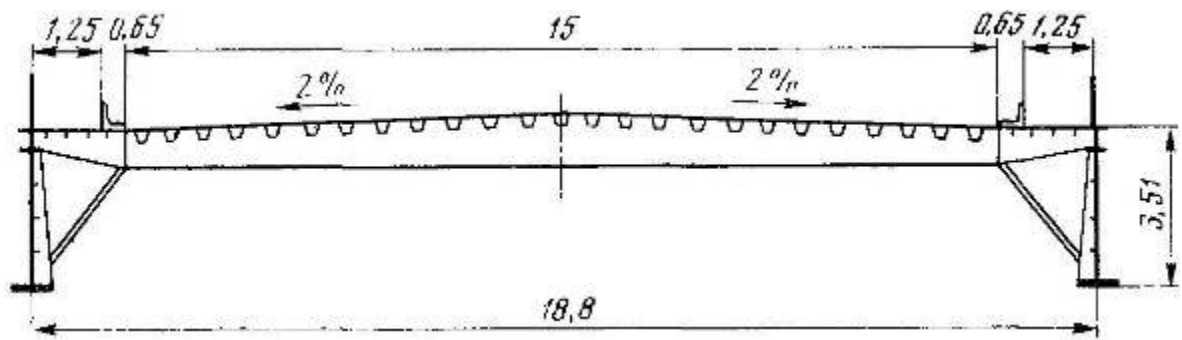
Поперечний переріз балки жорсткості з ортотропною плитою
